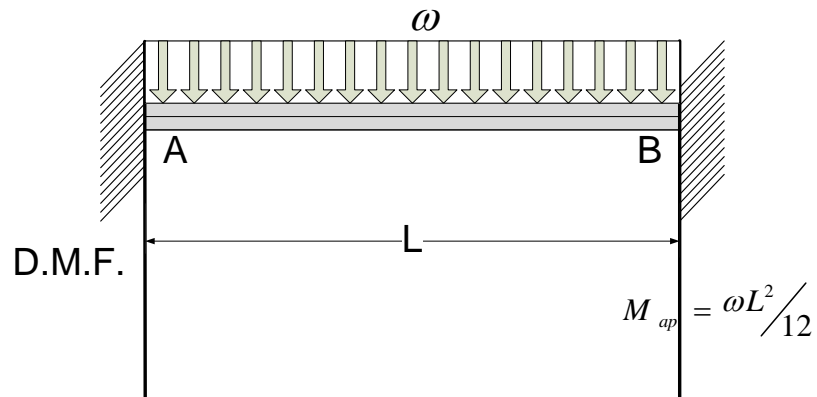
DOBLE EMPOTRAMIENTO DE VIGAS
